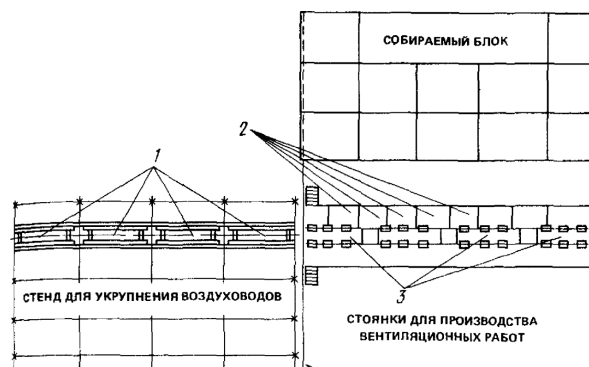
Схема организации работ при монтаже воздуховодов подъемным рольгангом в блоках покрытия на конвейере: 1 - контейнеры для воздуховодов; 2 - столы монтажные; 3 - подъемный рольганг
